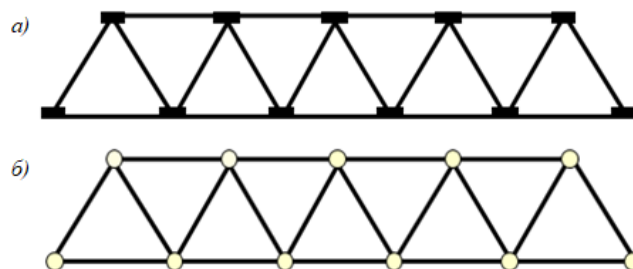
К понятию фермы и ее расчетной схеме
